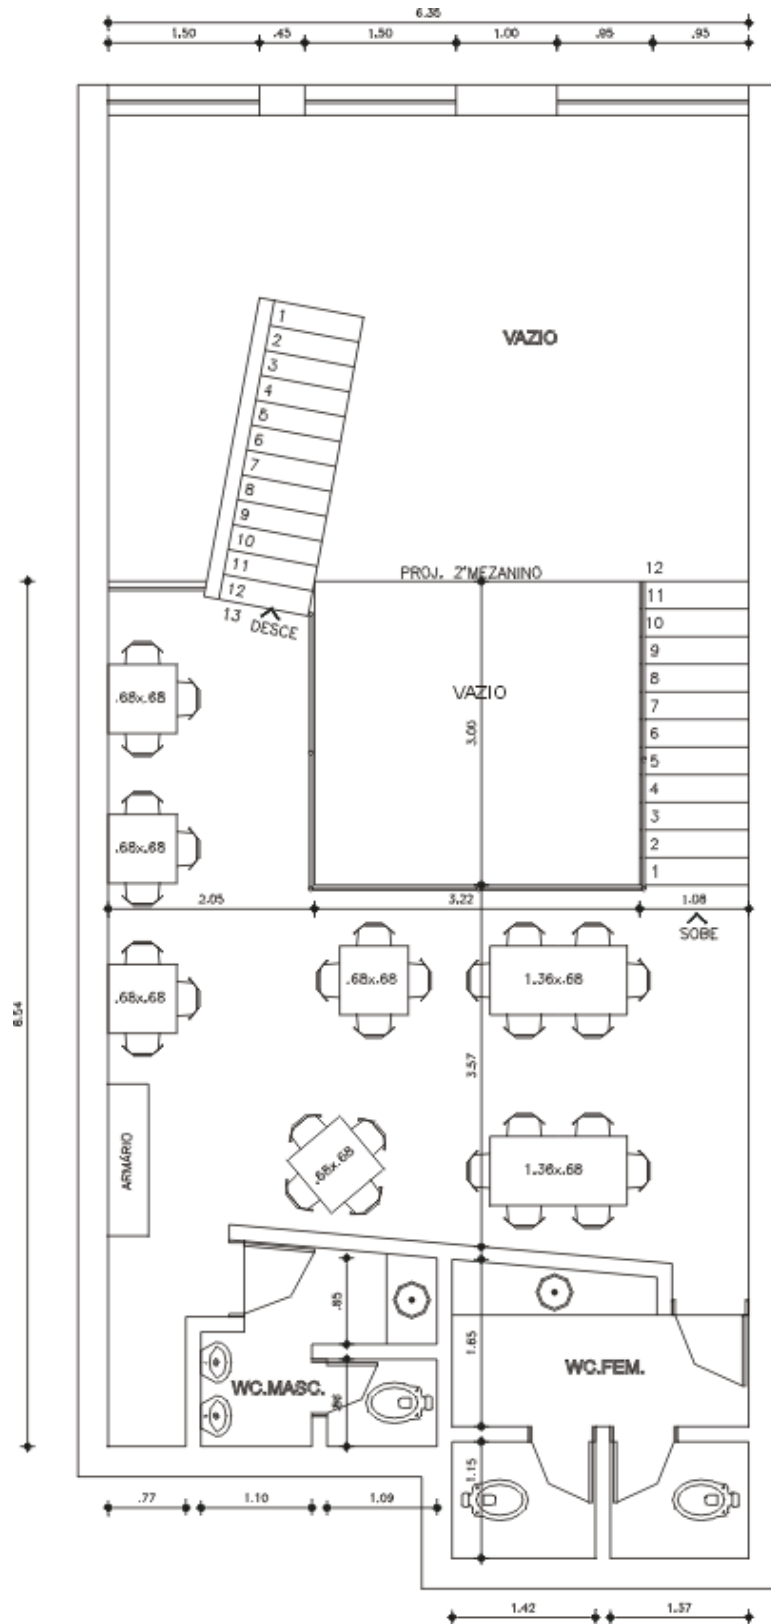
A – Planta baixa (lay-out) do primeiro mezanino.
